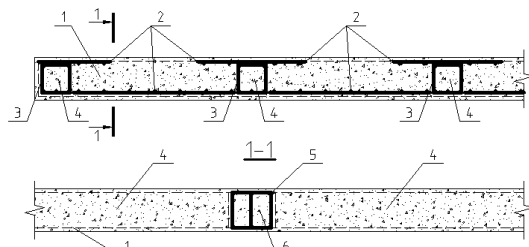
Монолитное железобетонное перекрытие: 1 – балочная плита; 2 – арматурные сетки плиты; 3 – каркасы «условных» второстепенных балок; 4 – «условные» второстепенные балки; 5 – каркасы «условных» главных балок; 6 – «условные» главные балки
